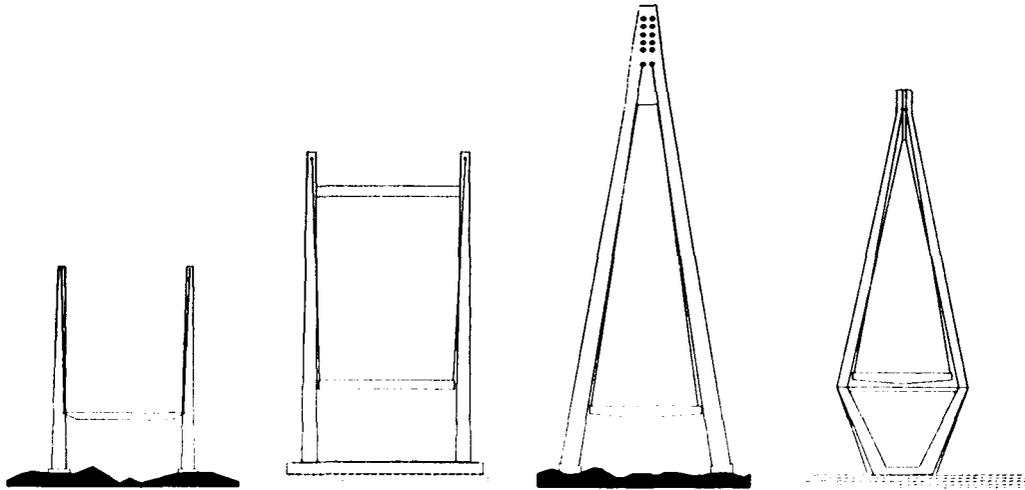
2 Formas de pilones usadas para suspensión a lo largo de los bordes del tablero
